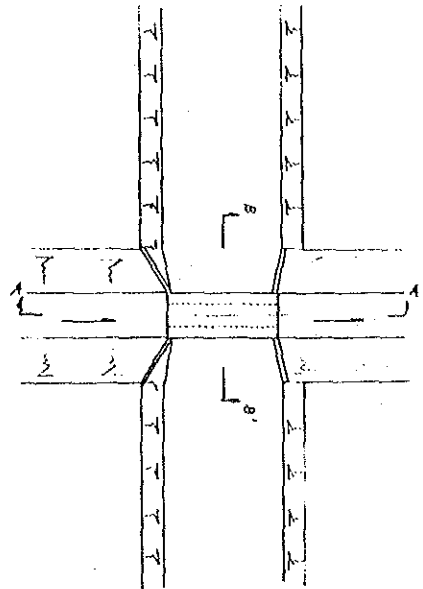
Drenaje de Caminos (Alcantarilla)
